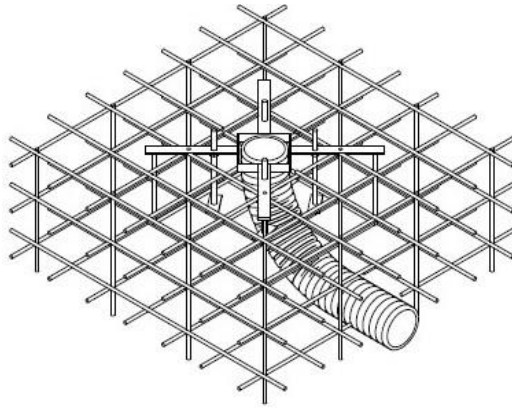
Трехмерная схема армирования бетонного основания
